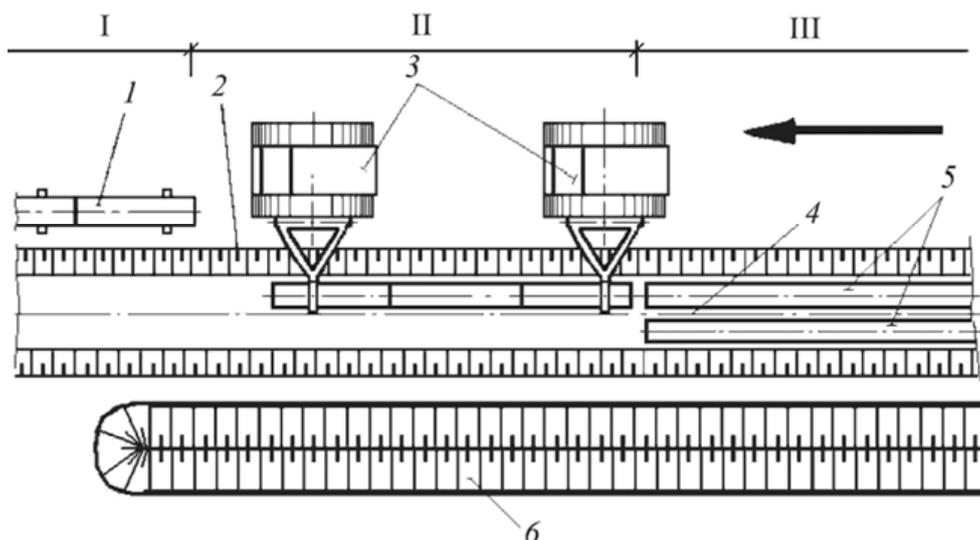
Схема монтажа участка трубопровода: I — зона сборки труб в плети на бровке траншеи; II — зона укладки плетей труб в траншею; III — зона испытаний трубопровода: 1 — плети труб; 2 — траншея; 3 — трубоукладчики; 4 — ось траншеи; 5 — трубопровод; 6 — отвал грунта
